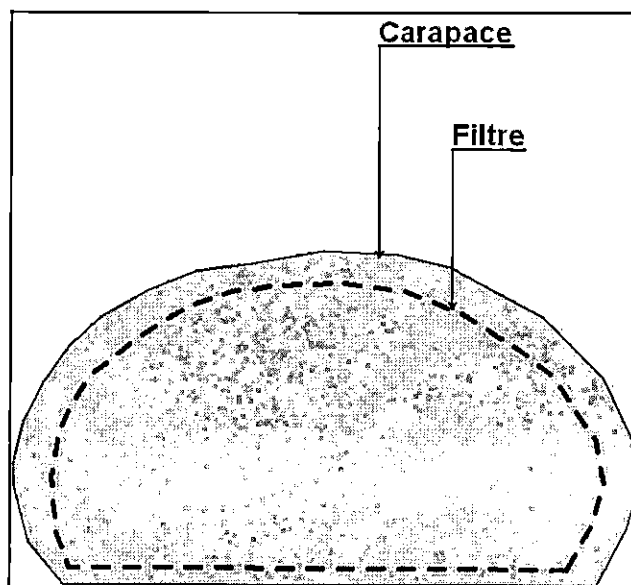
Coupe transversal d'un système de stabilité de plage (stabiplage, 2006)
